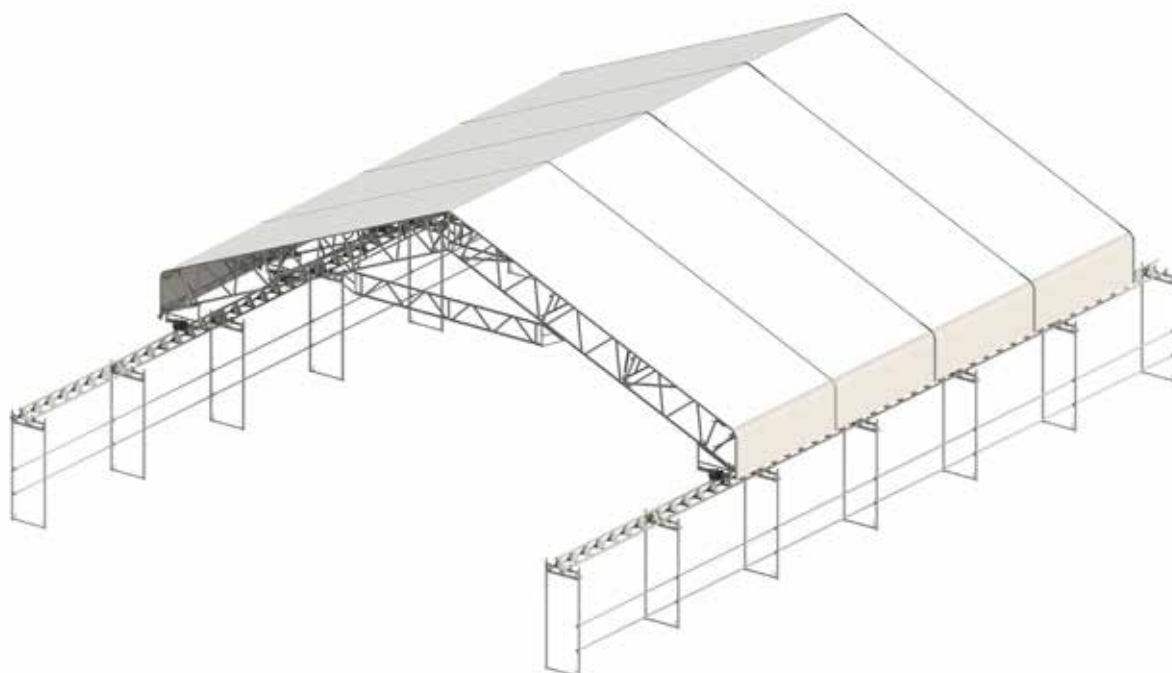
Montaż plandek w profilach specjalnych dachowych systemu DELTA DACH.
